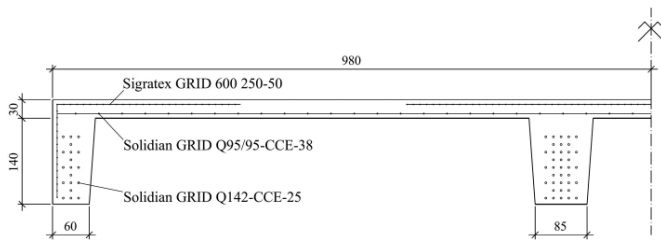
Querschnitt der untersuchten TT-Platte (Abmessungen in mm)
